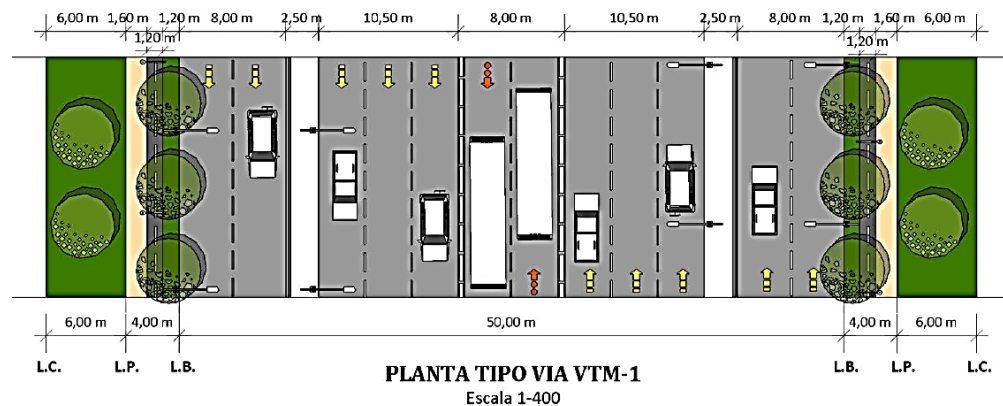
Planta del Perfil Proyectado Ampliación Carrera 38. Fuente Formulación Plan de Ordenamiento Territorial 2012 – 2032
